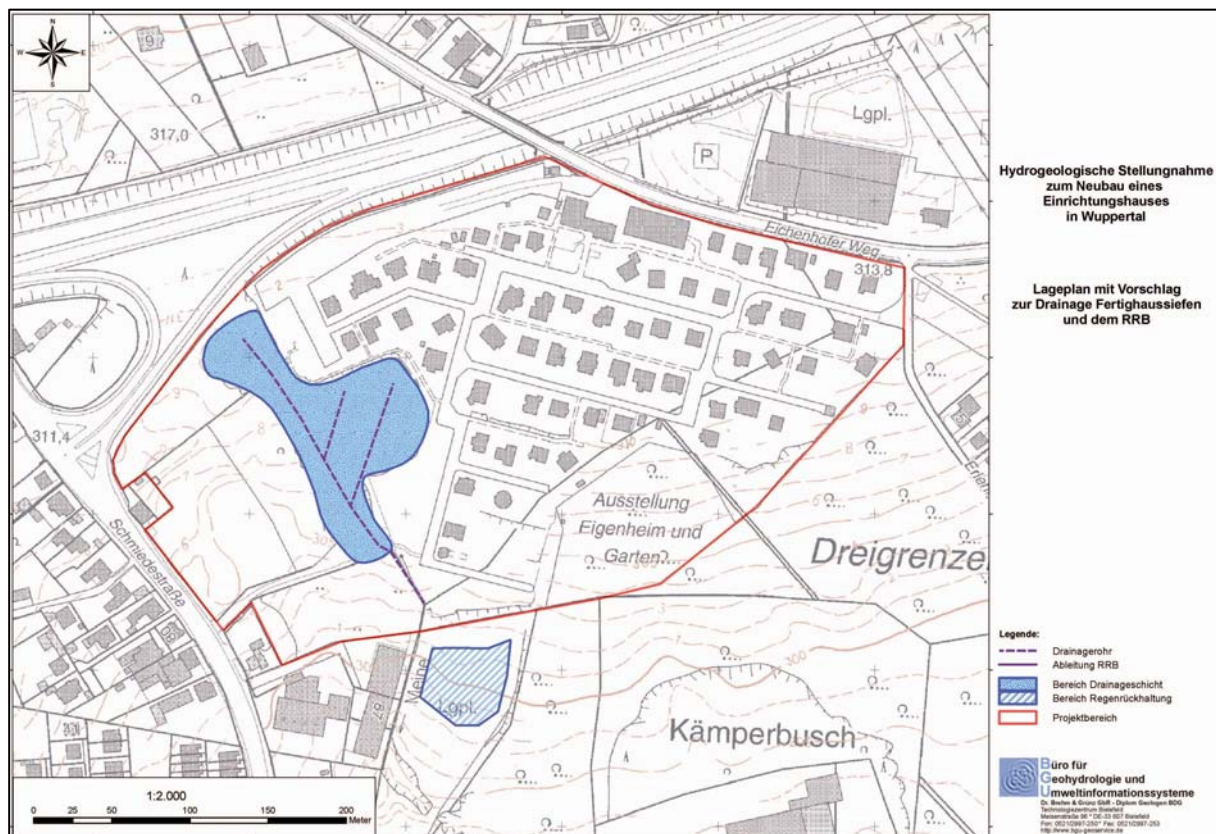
Lageplan mit Vorschlag zur Drainage des Teilbereichs A, Quelle: Hydrologisches Gutachten [1].
